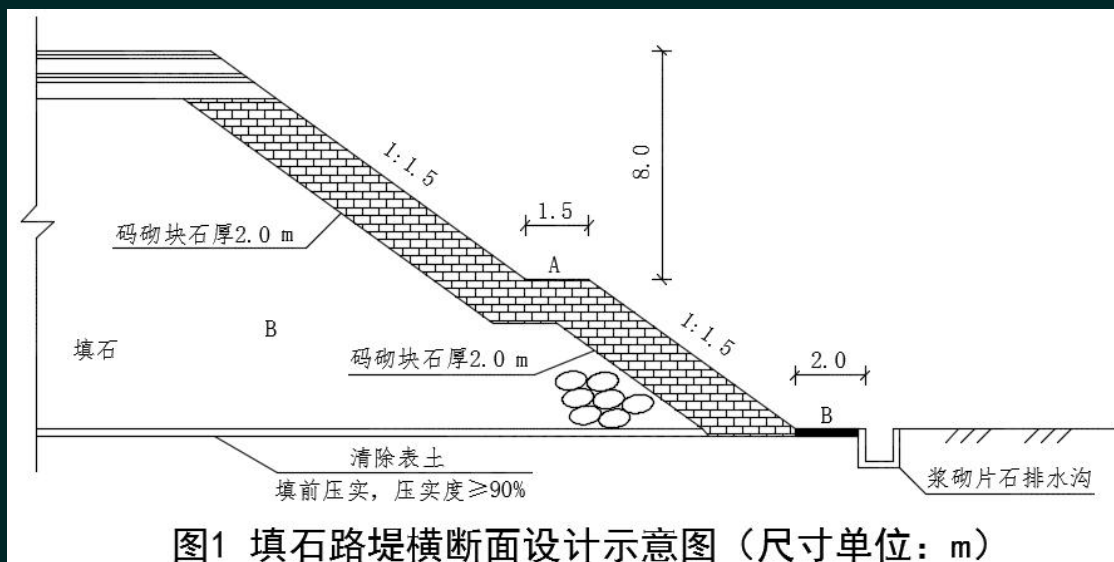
填石路堤横断面设计示意图 (尺寸单位: m)
